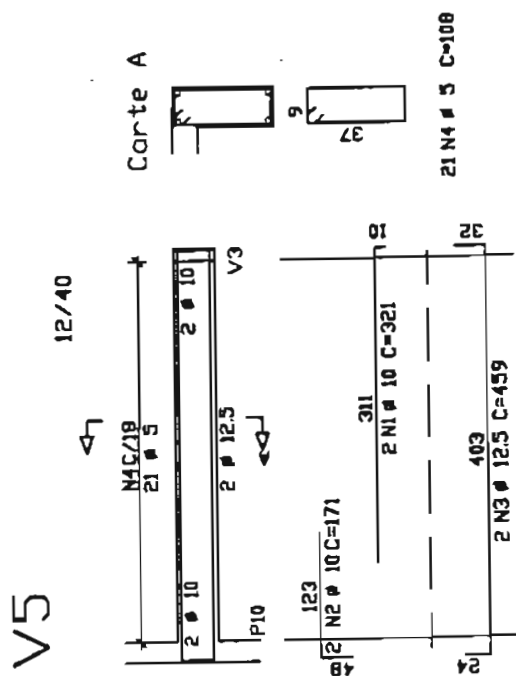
Detalhe de armadura da viga V5 (pórtico simplificado)
